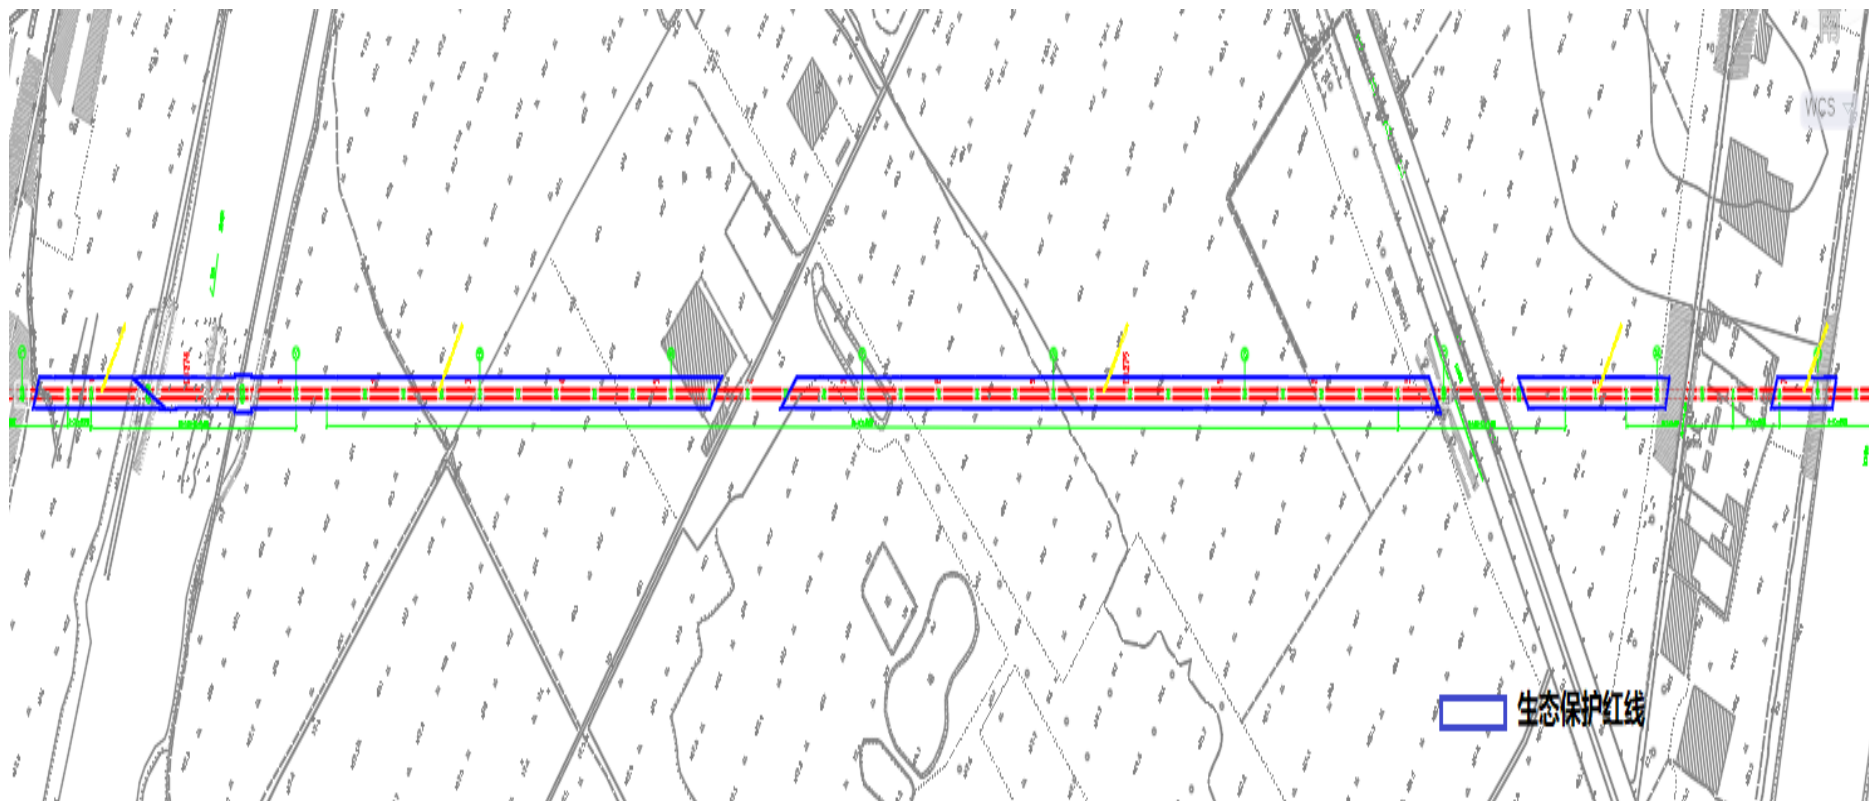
跨越衡水湖自然保护区段桥梁平面位置示意图
